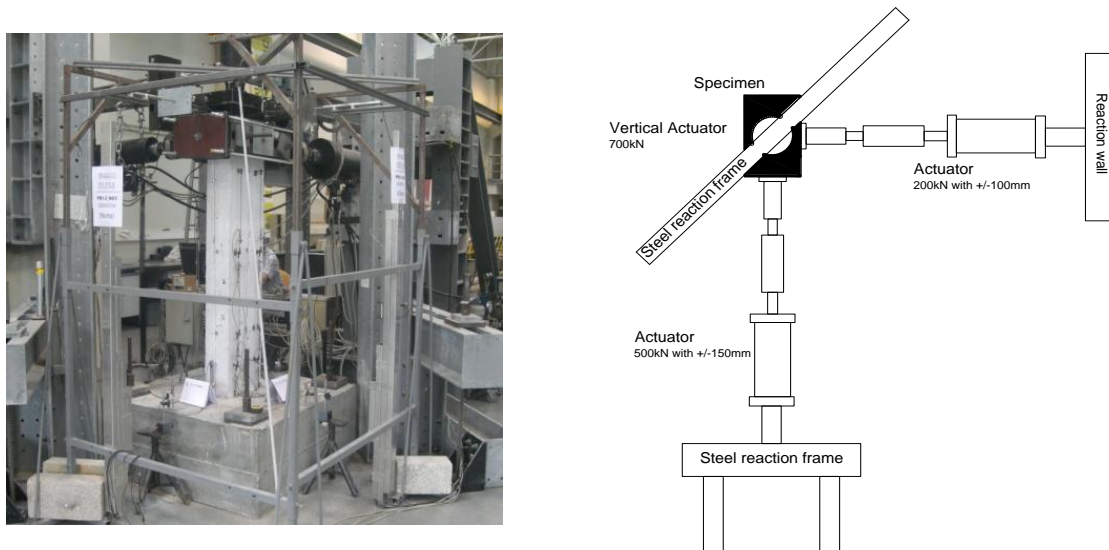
Esquema de ensaio: a) vista geral e b) esquema em planta do setup de ensaio
